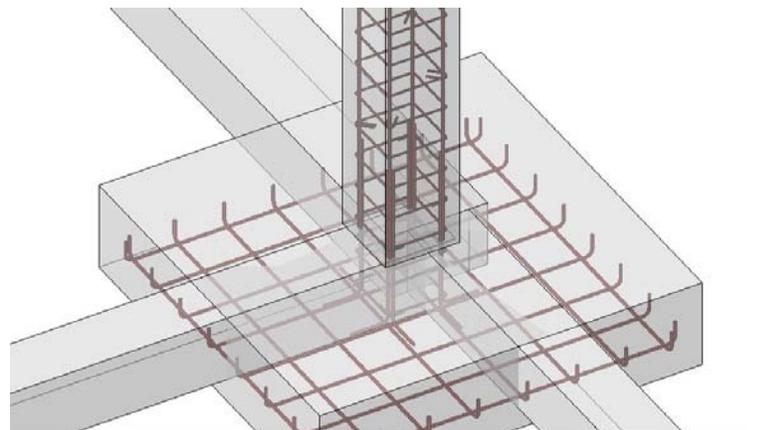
DETALLE DE ZAPATAS AHILADAS
